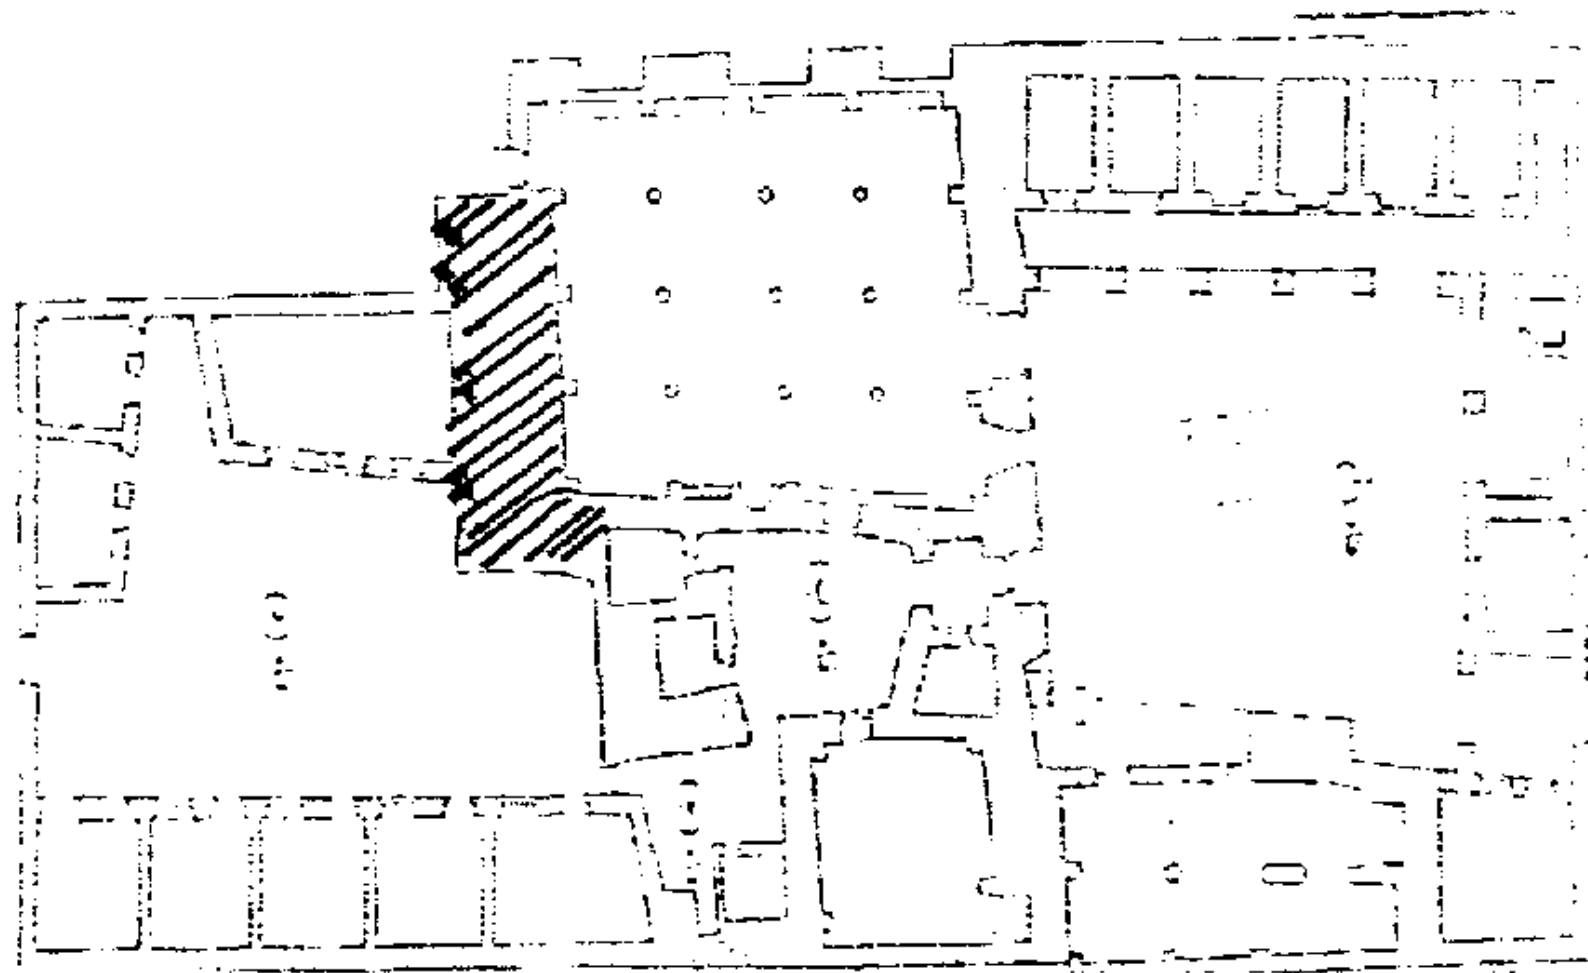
مسقط أفقي لجامع محمود عن الموسوعة (الجزء الأول).
